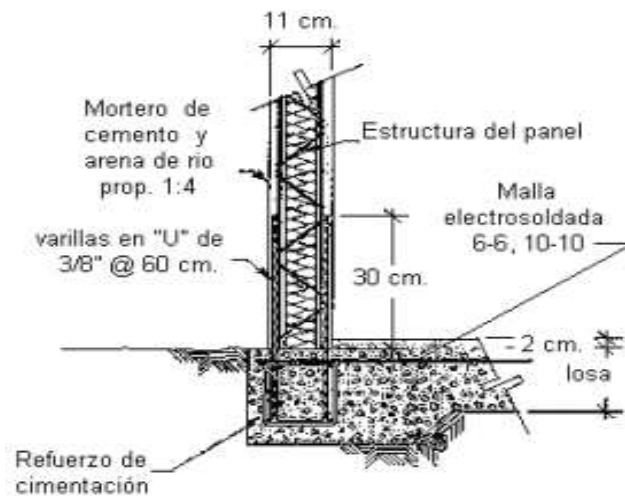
Detalle del anclaje del muro con núcleo de icopor
